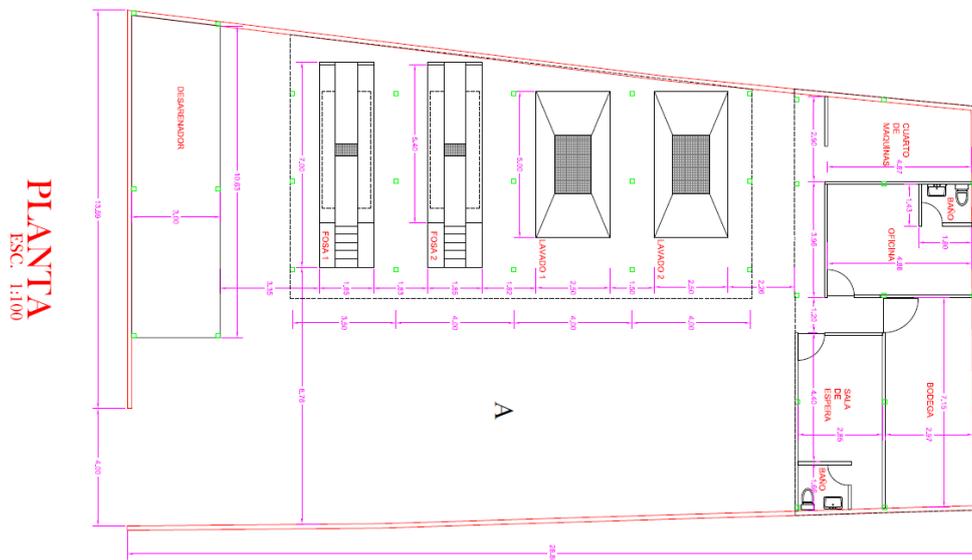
Plano de planta, descripción de diseño de estructura del centro de auto lavado.
